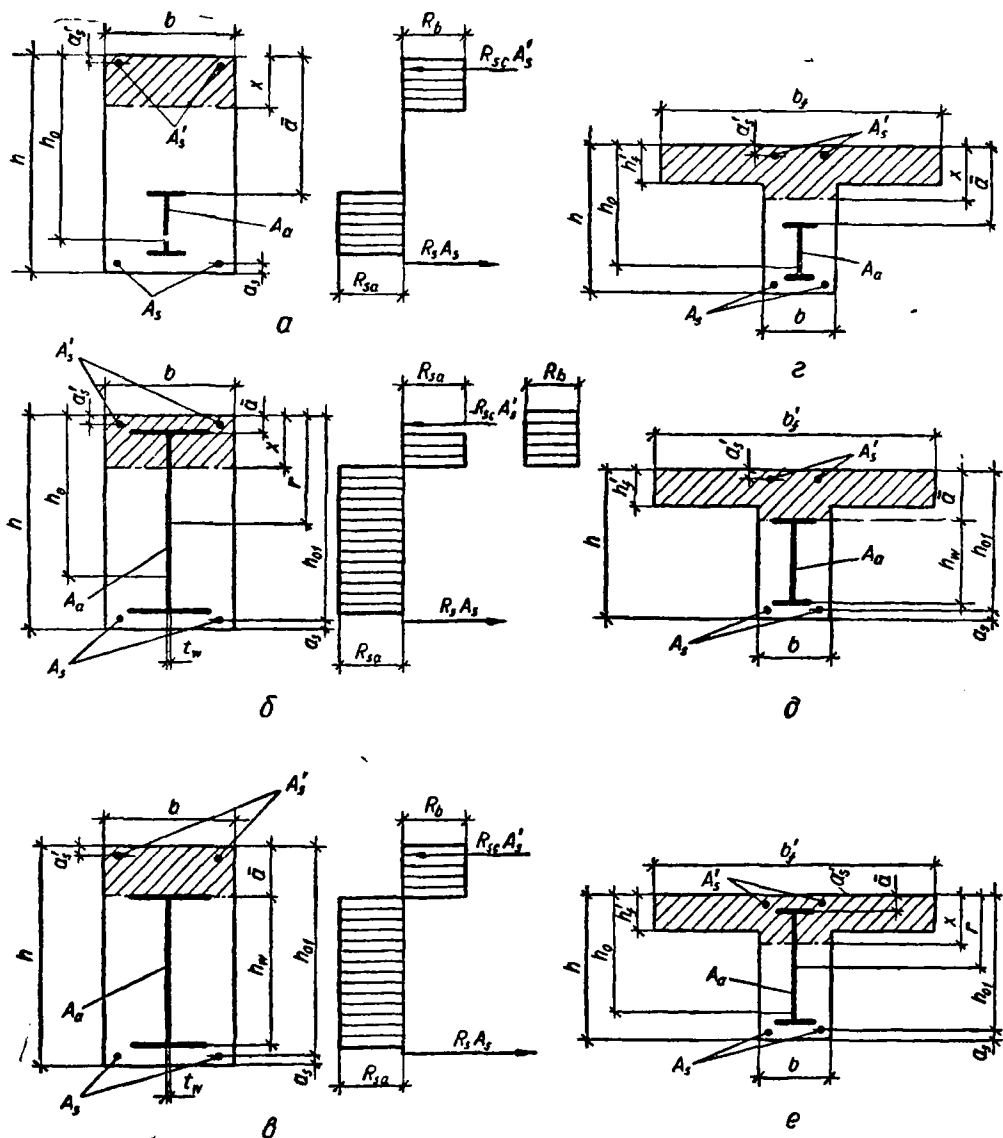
Поперечні перерізи з жорсткою арматурою і схеми розподілу зусиль:
